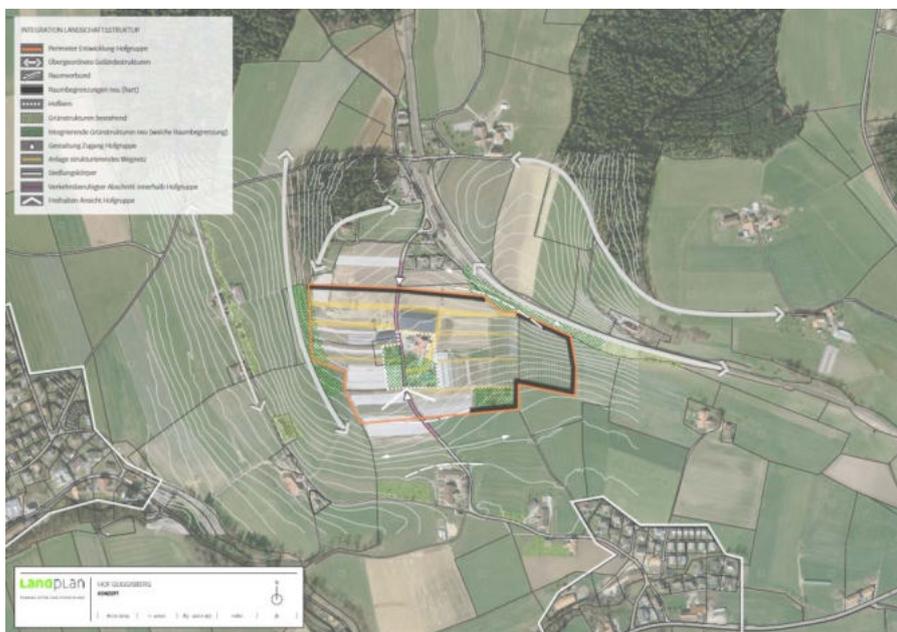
Plan Konzept im Massstab 1:4'000 (siehe Anhang 2)
